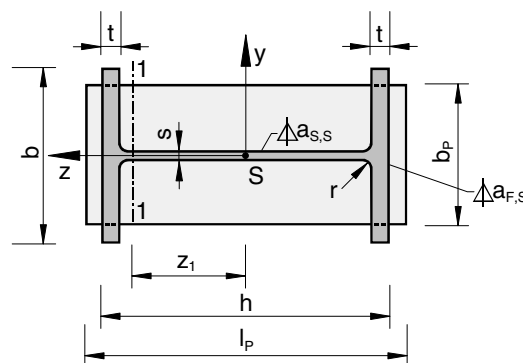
Fußplatte mit Schweißnähten
